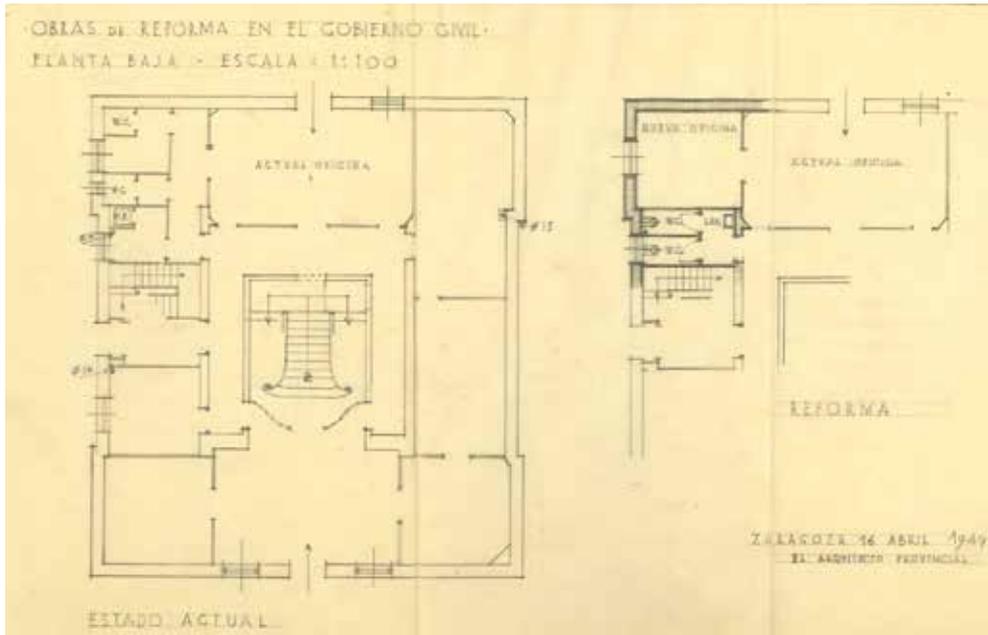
Obras de reforma en la planta baja del edificio del Gobierno Civil, por el arquitecto Teodoro Ríos, 16 de abril de 1949 (Archivo de la Diputación Provincial de Zaragoza).
